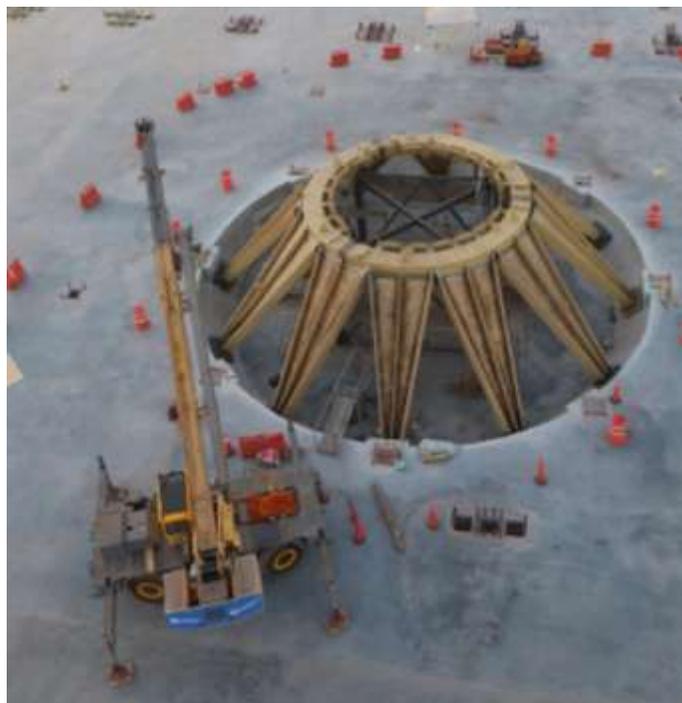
, Vista Aérea de Armado de Fonil y Anclaje a Cimentación.
